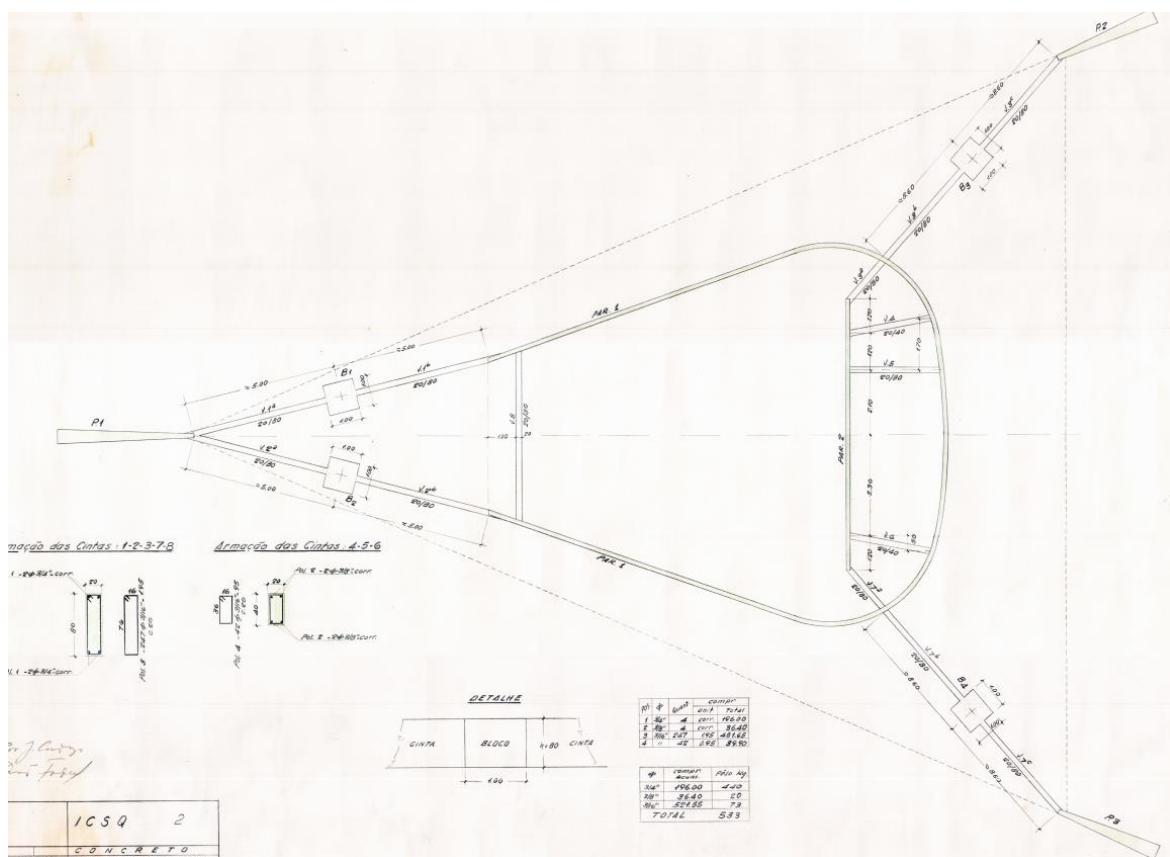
Planta de formas e de armação das cintas (vigas baldrame). Fonte: Arquivo Público do Distrito Federal, 2022.
